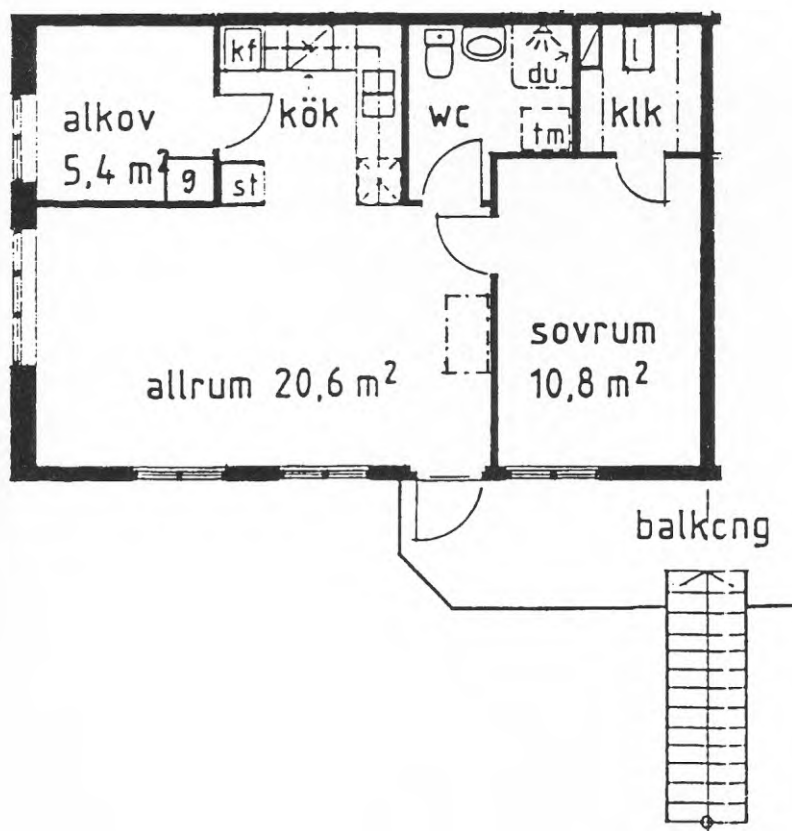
7. Möblerad plan av lägenheter typ 1 och typ 2. Skala 1:100. Ur tävlingshandlingarna av Skanska AB och White Arkitekter, 1991–08–28.
